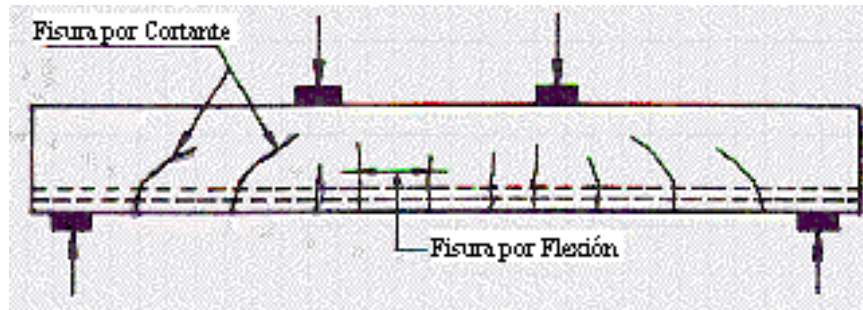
Típicas fisuras por flexión y por cortante en una viga simple (Inducidas por cargas).
